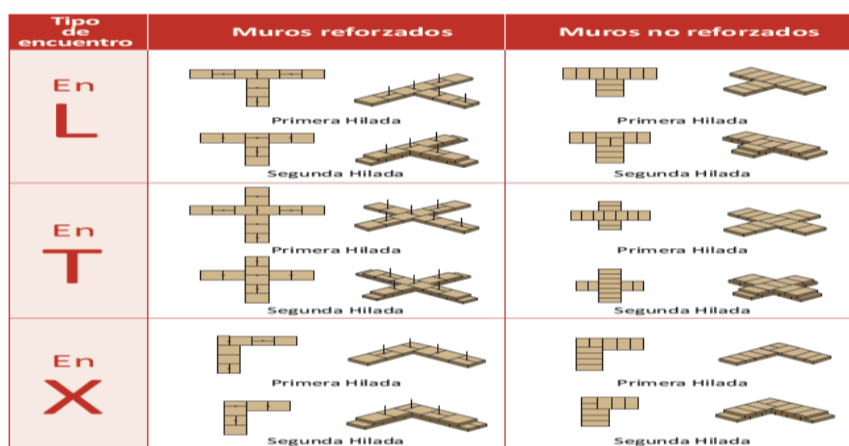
Tipos de amarre en muros de adobe con o sin refuerzo.
